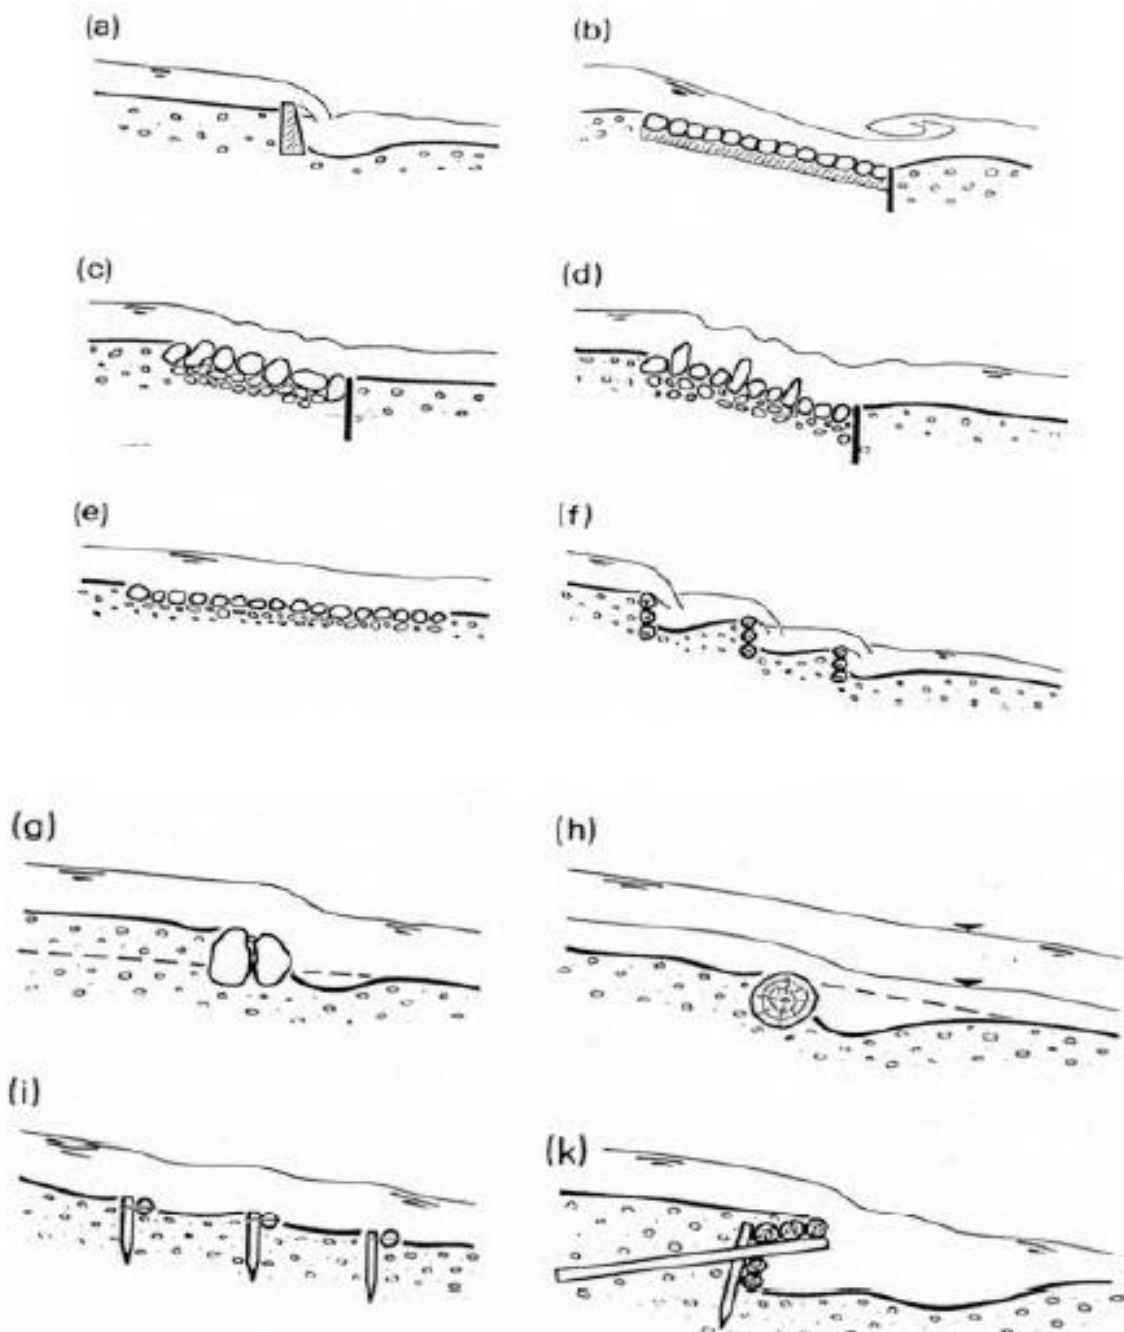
Les ouvrages transversaux : a) Seuil b) Coursier bétonnier c) Rampe des blocs
